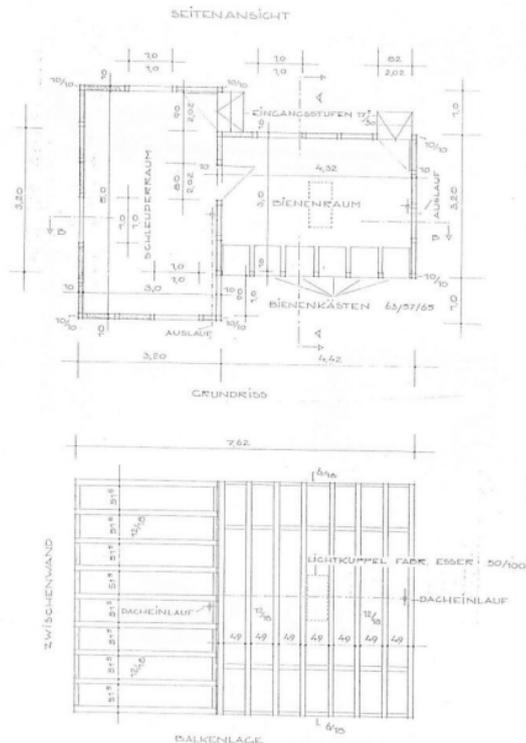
Die architektonischen Ausführungen von W.KINSKI verbinden zahlreiche fachliche und fachdidaktische Überlegungen zu einem fachgerechten Bauplan.
